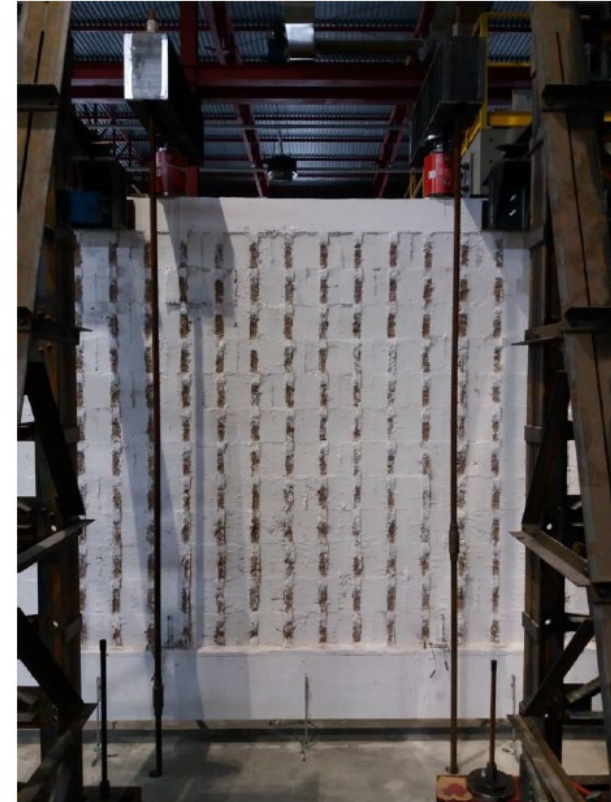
fessurazione capillare della trave-parete con luce 6 m (configurazione A)
